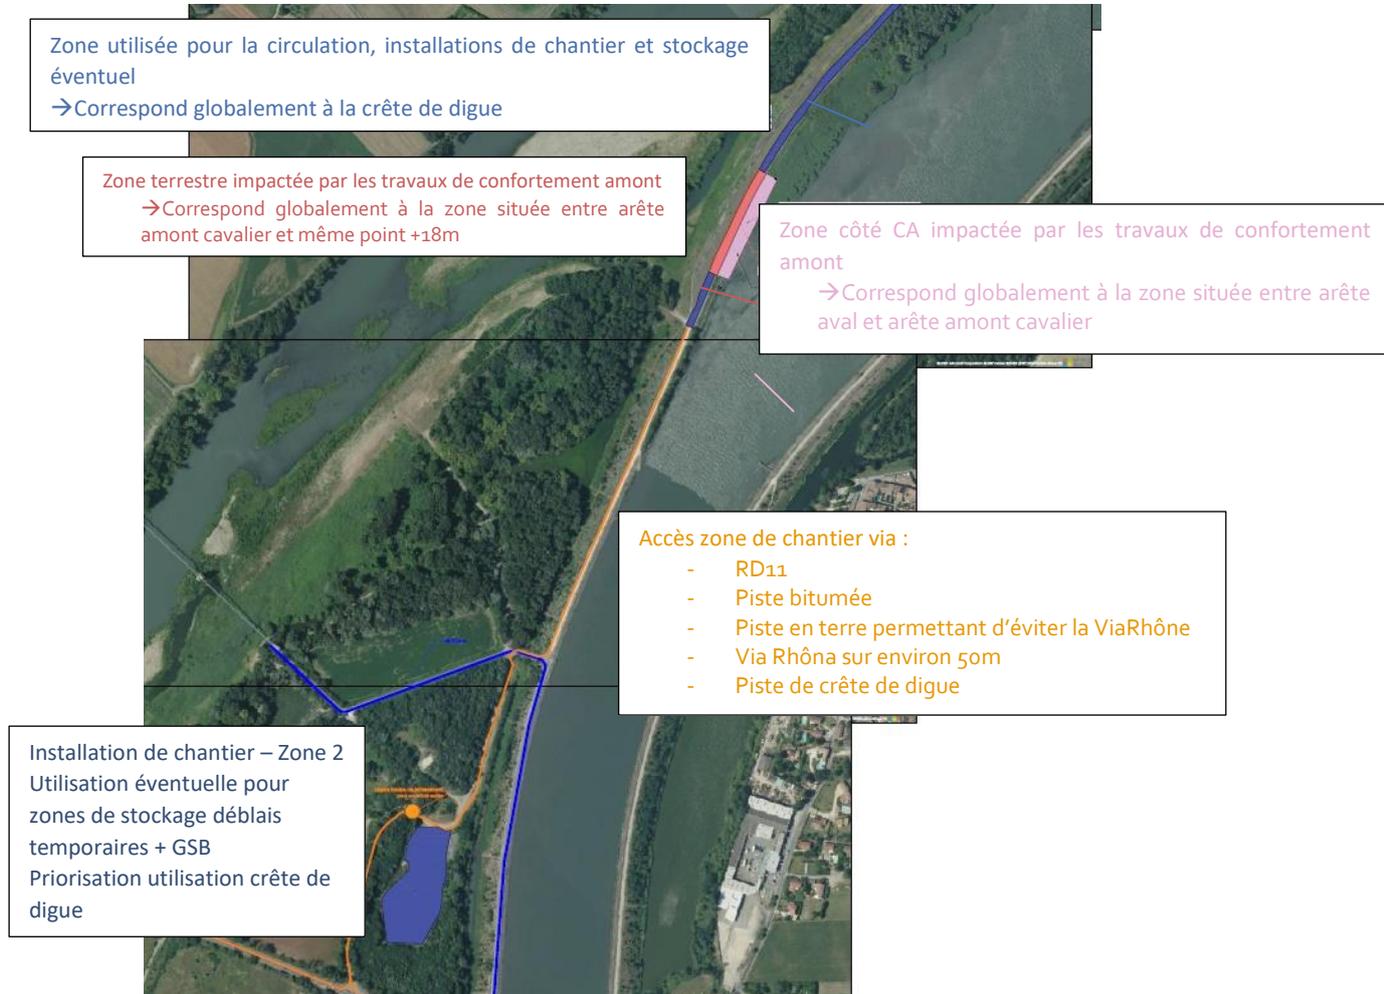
Plan des travaux de la phase 1 (source CNR)
